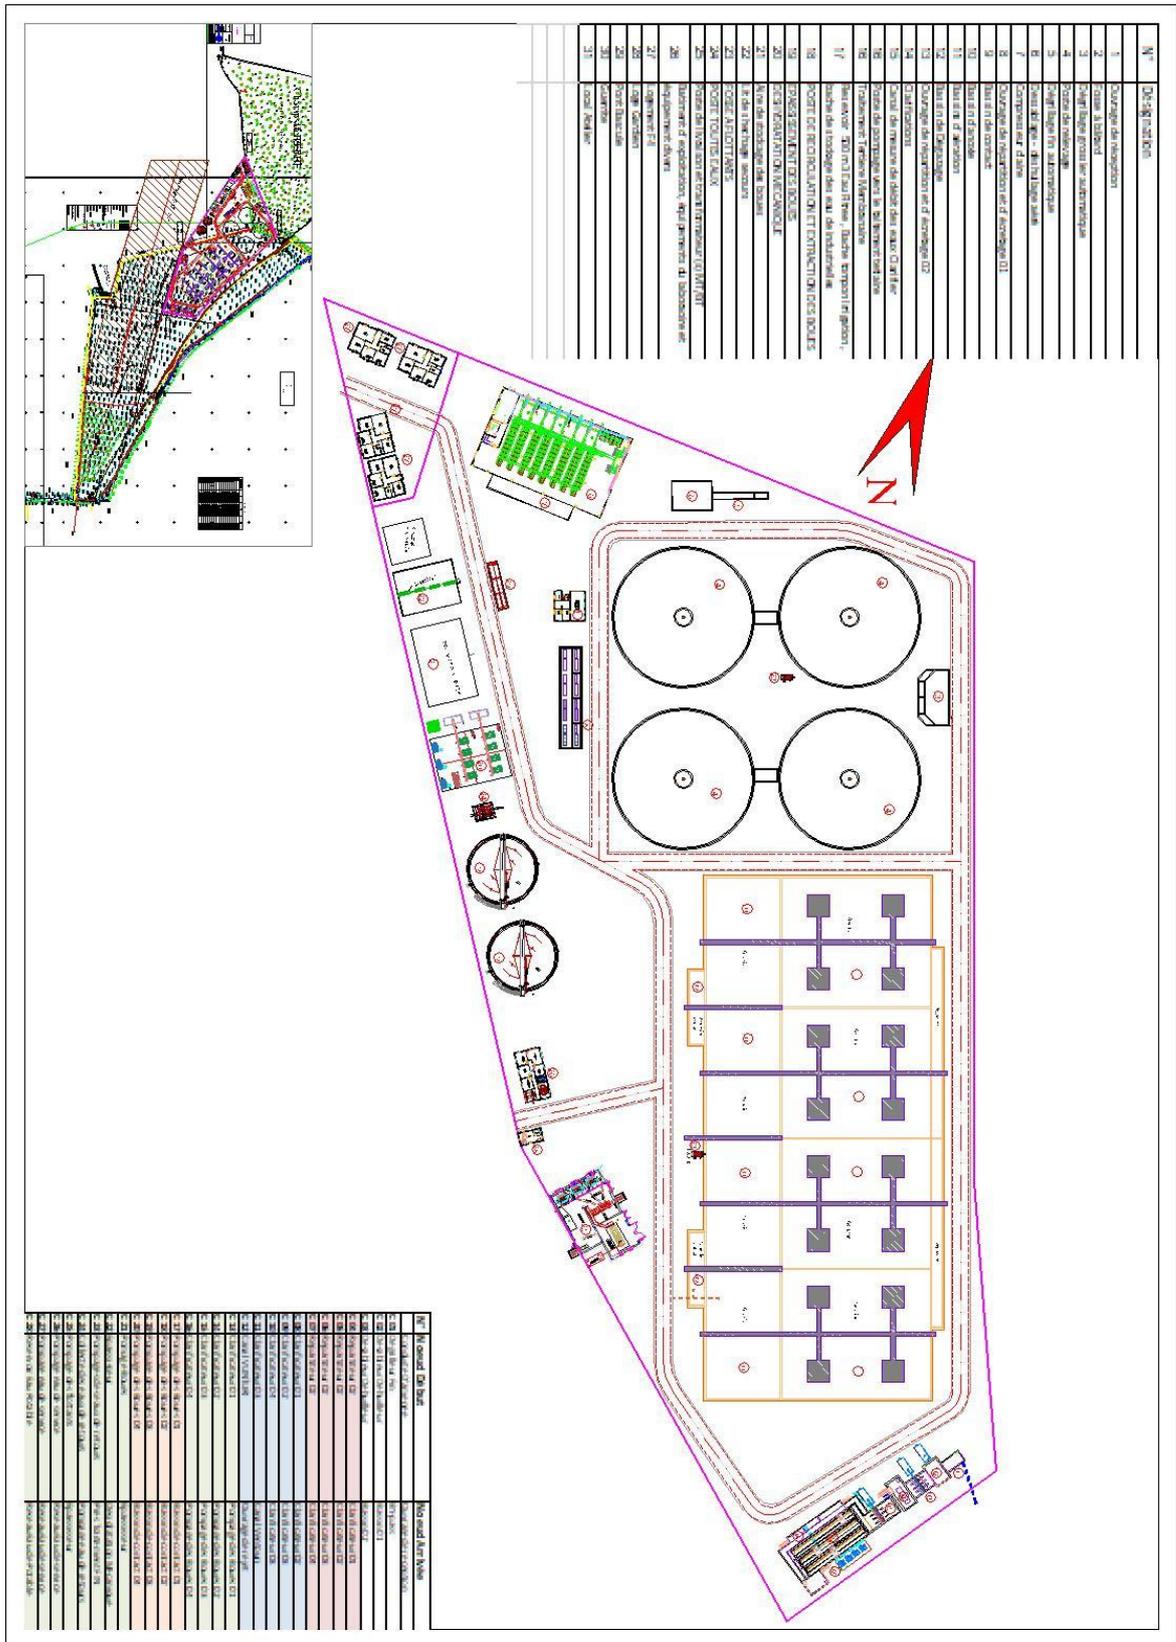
Le plan proposé pour l'aménagement de la STEP.
